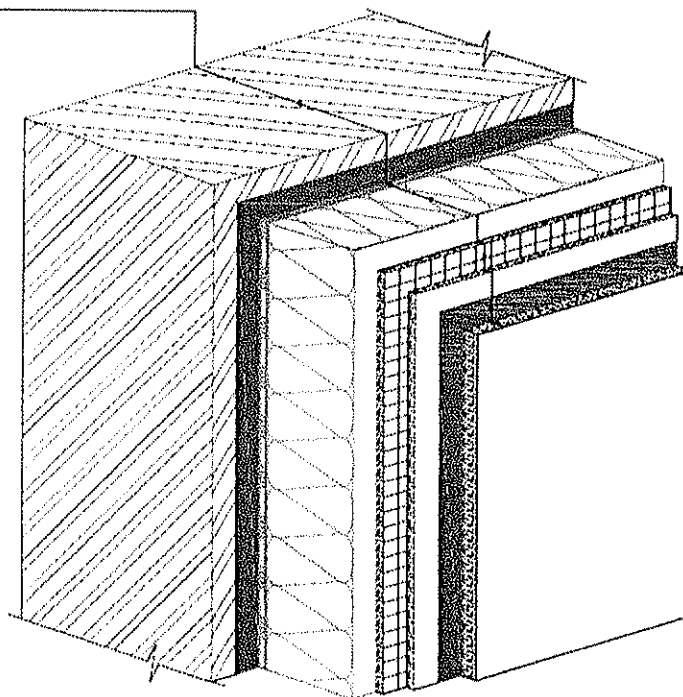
Схема расположения слоев фасадной системы на фрагменте стены испытательной установки.
